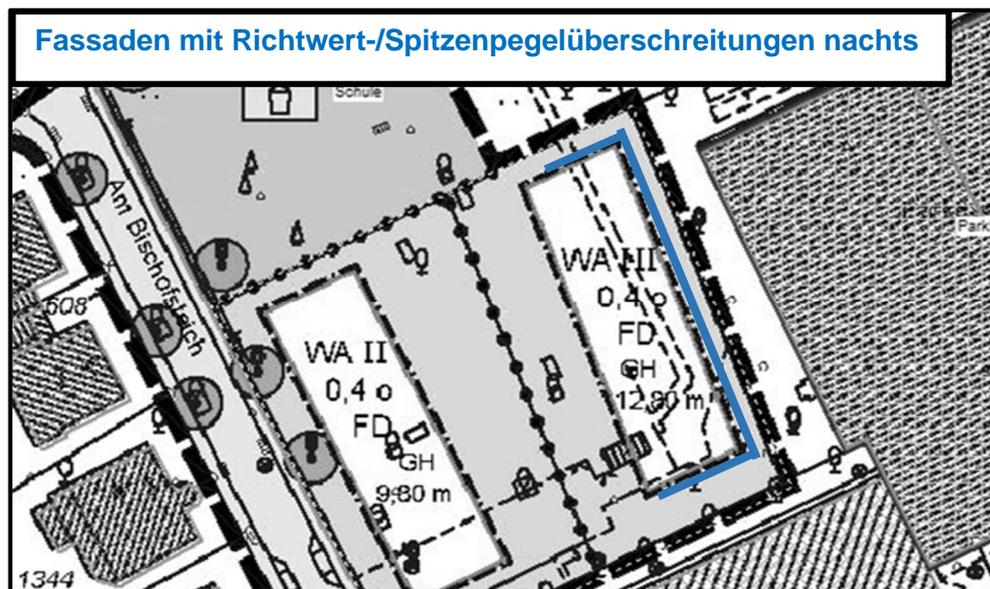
Zusammenfassung Fassaden mit Überschreitungen nach TA Lärm an dem östlichen Plangebäude
